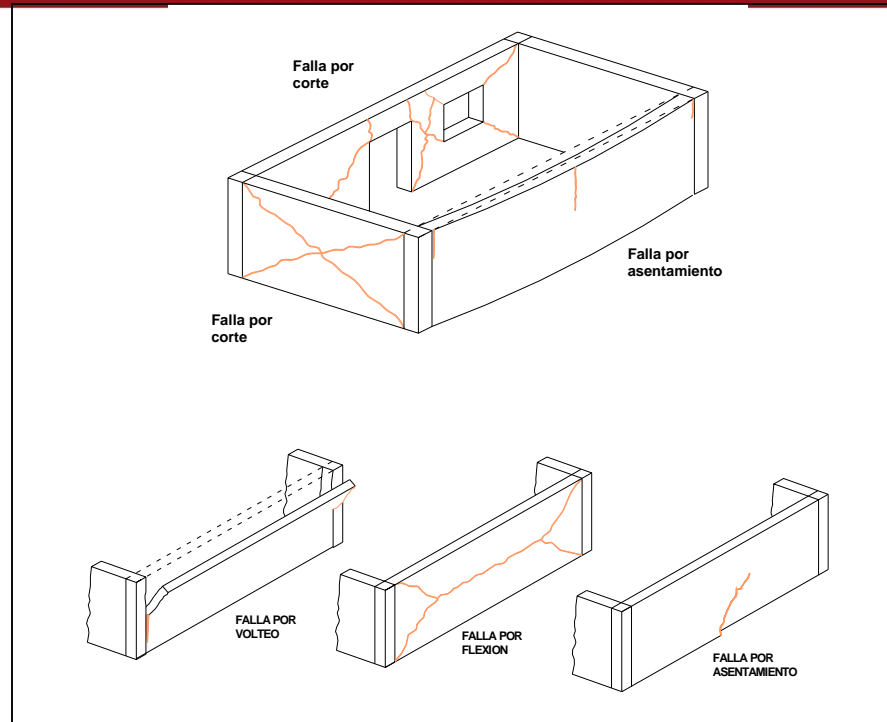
Grietas estructurales (Iglesias y Robles 1988)
